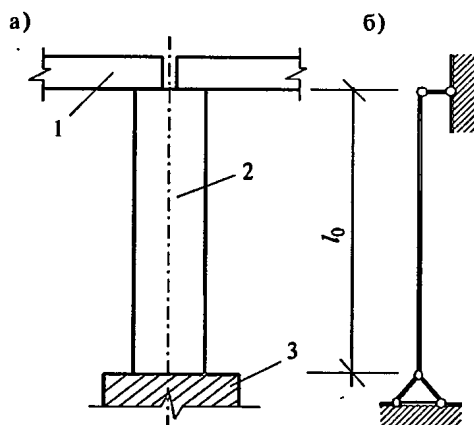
Соединение кирпичной колонны с балкой и фундаментом:
